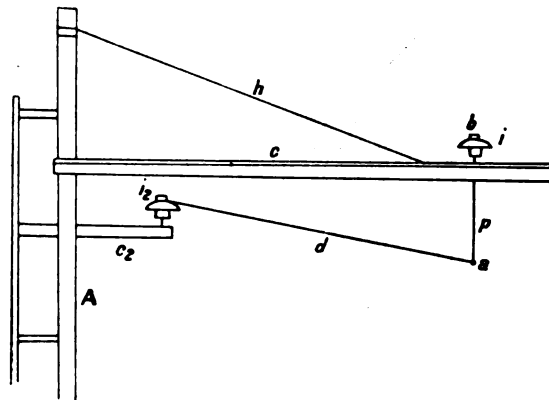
Suspension Westinghouse pour portées de 60 m.
